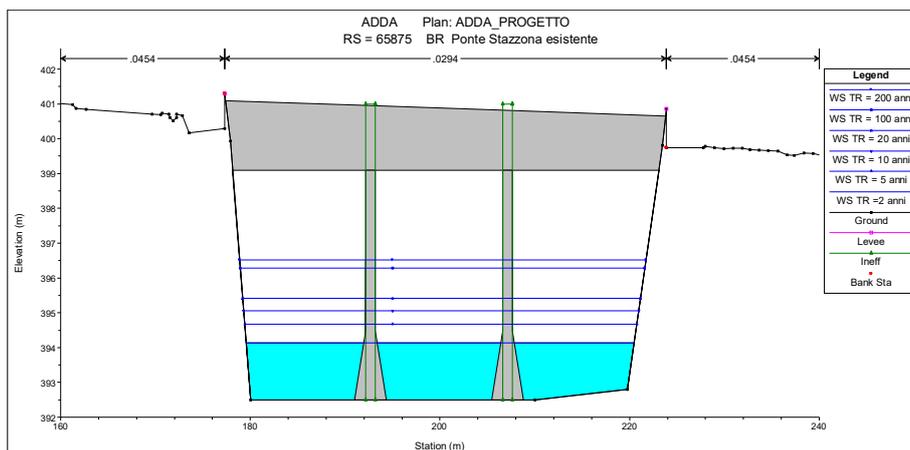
Sezione del fiume Adda presso il ponte esistente di Stazzona (R.S. 65875), stato di progetto
